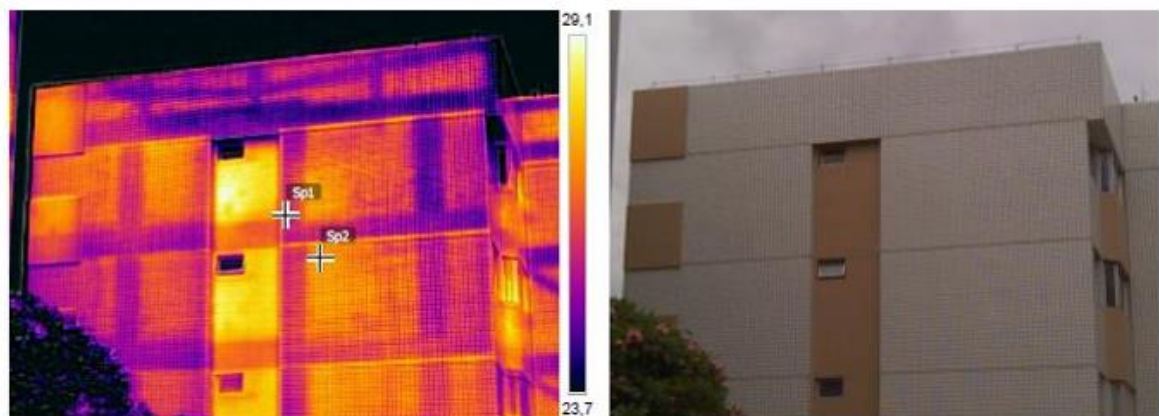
Localização da tubulação do dreno de ar condicionado – Verificação de vazamento
